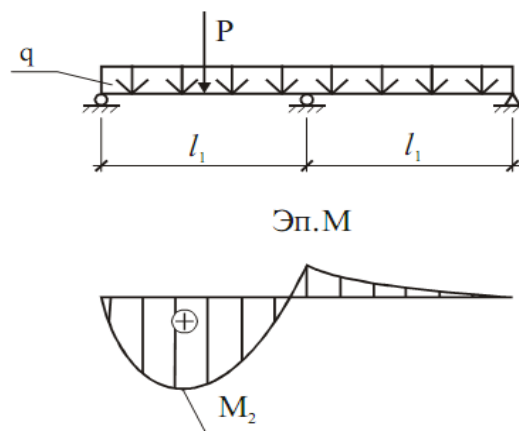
Расчетная схема обрешетки для второго случая сочетания нагрузок
